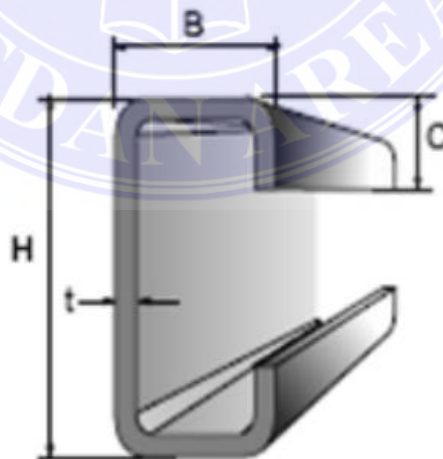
Profil baja UNP (*Tabel Profil Konstruksi Baja*)
